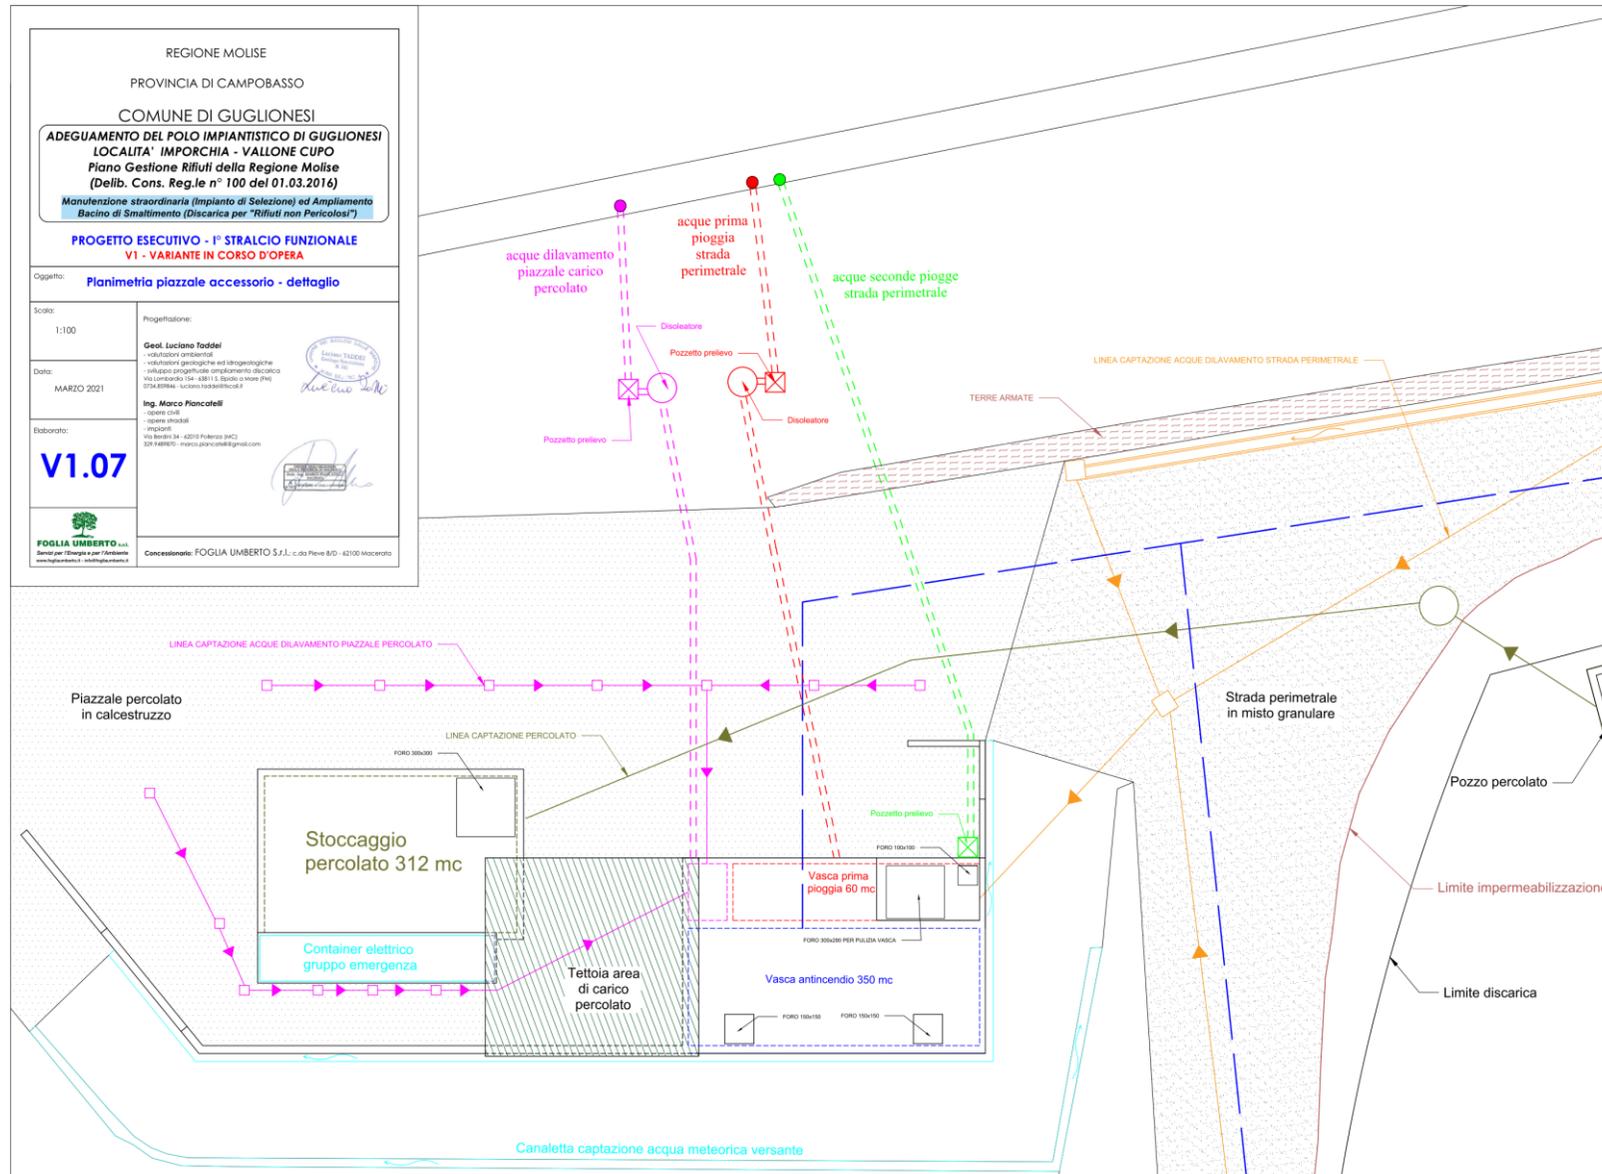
planimetria del piazzale accessorio: assetto "post operam"
